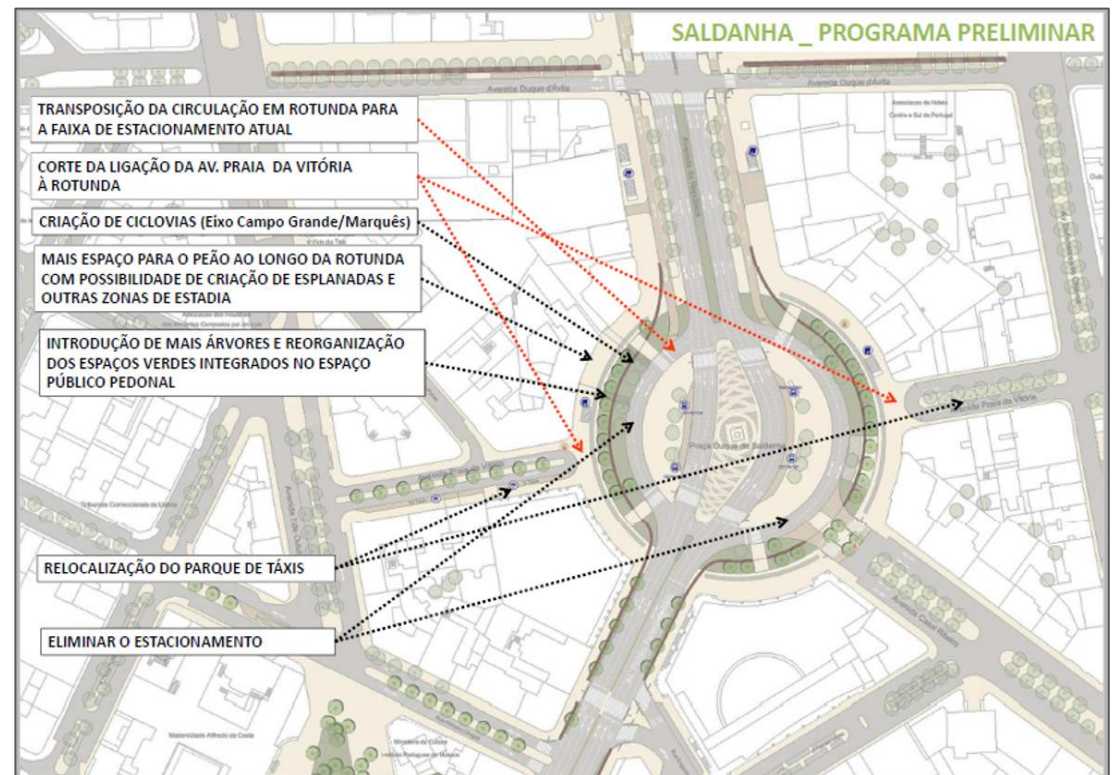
Planta Síntese das Propostas para a Praça Duque de Saldanha
